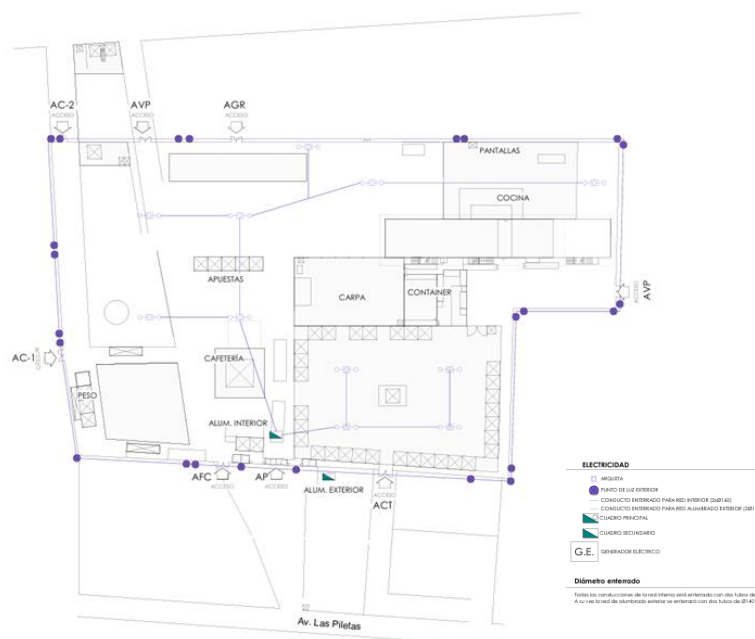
Distribución de las instalaciones de electricidad. Red de alumbrado. Fuente: Plano I-04 Proyecto de infraestructuras soterradas permanentes para el evento Carreras de Caballos en playa de Sanlúcar. Avenida de las Piletas, S/N, Sanlúcar de Bda (Cádiz).
